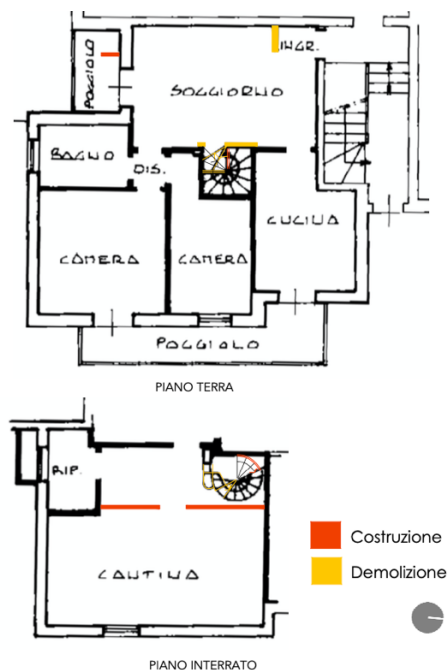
Sovrapposizione tra lo stato reale dei luoghi e la planimetria catastale
